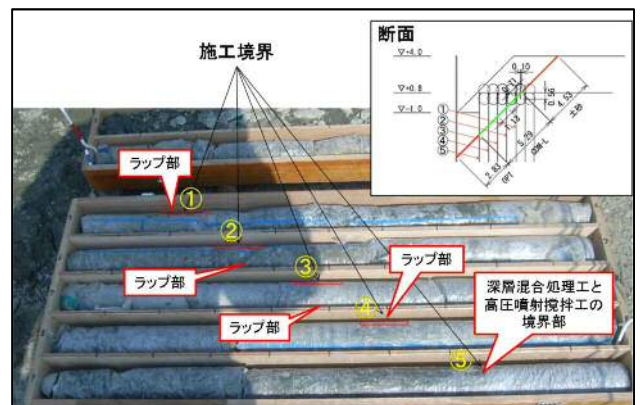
固化改良体ラップ部の接合状態（斜めボーリング）
